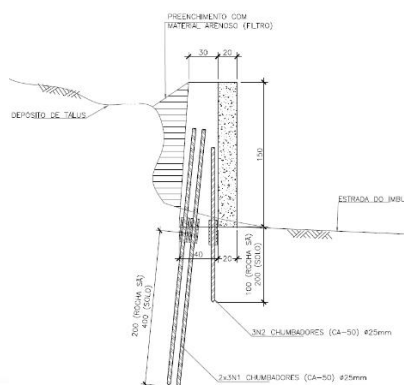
Detalhamento do muro chumbado em rocha (vista lateral)
